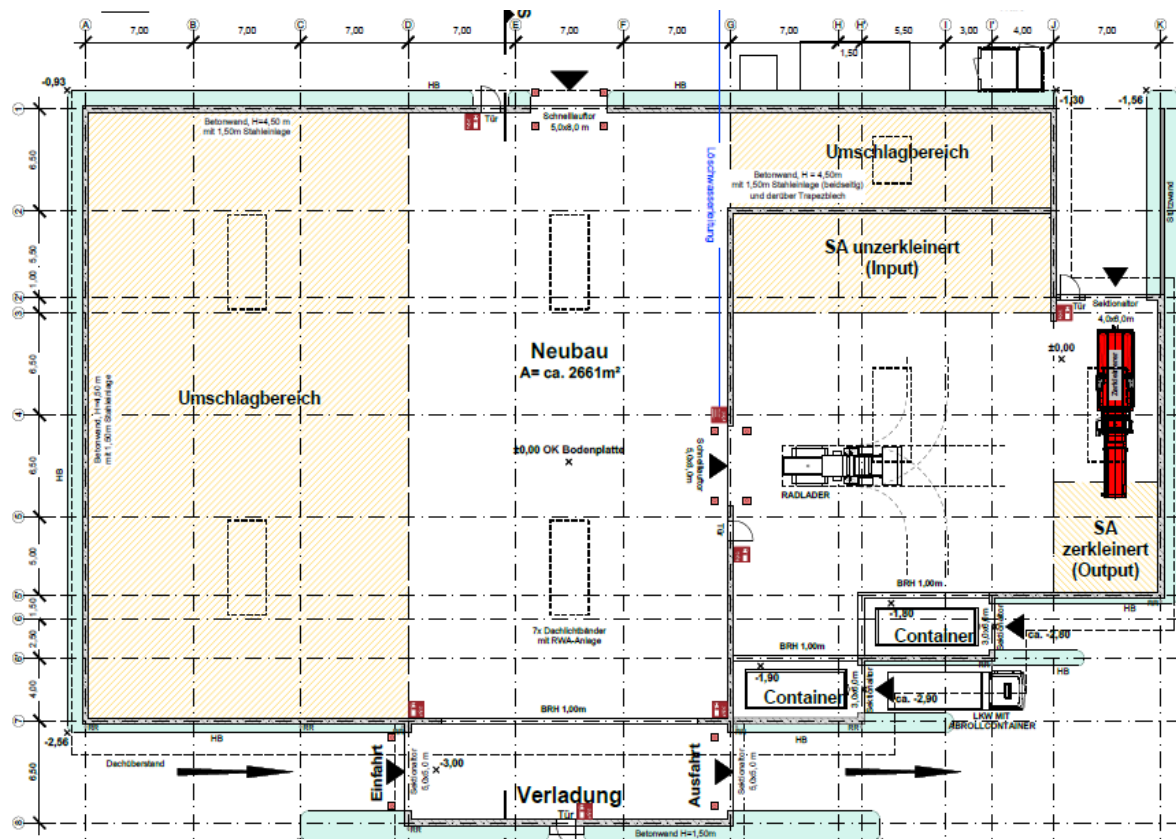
Ausschnitt Plan G 05 (Quelle SCHIRMER UT)
